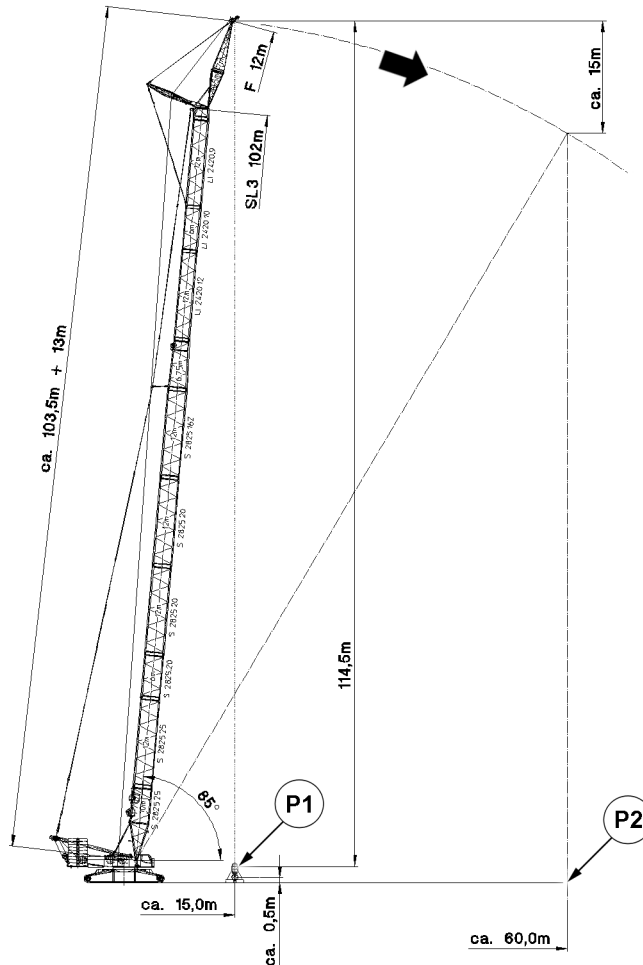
LR 1600-2, SL3F: Bobinar o cabo de içamento com pré-tensão
